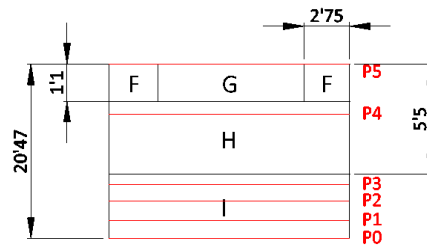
Modelo de cargas debidas al viento frontal sobre los pórticos de la primera planta.
